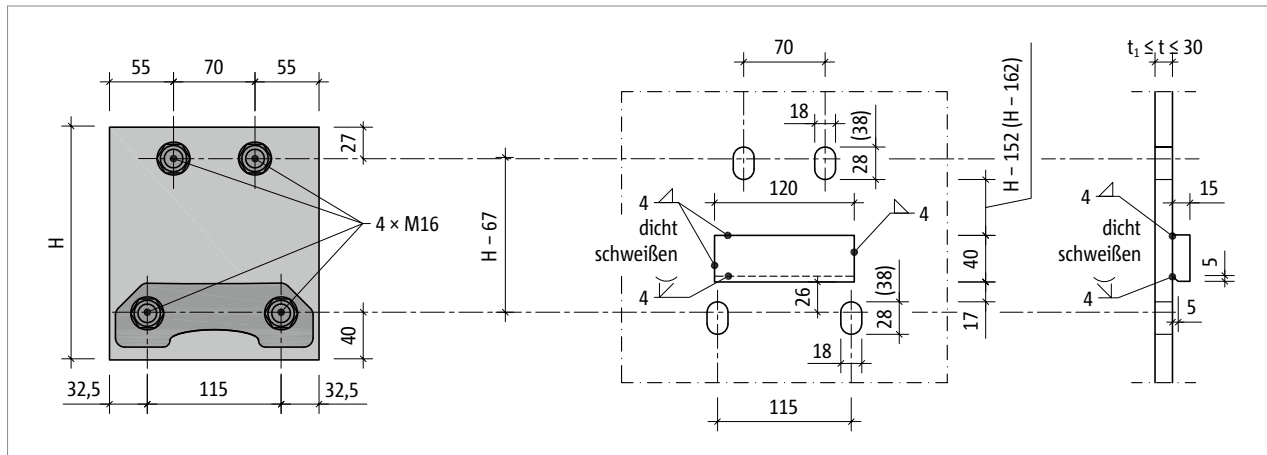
Schöck Isokorb® T Typ SKP-M1: Konstruktion des Stirnplattenanschlusses
